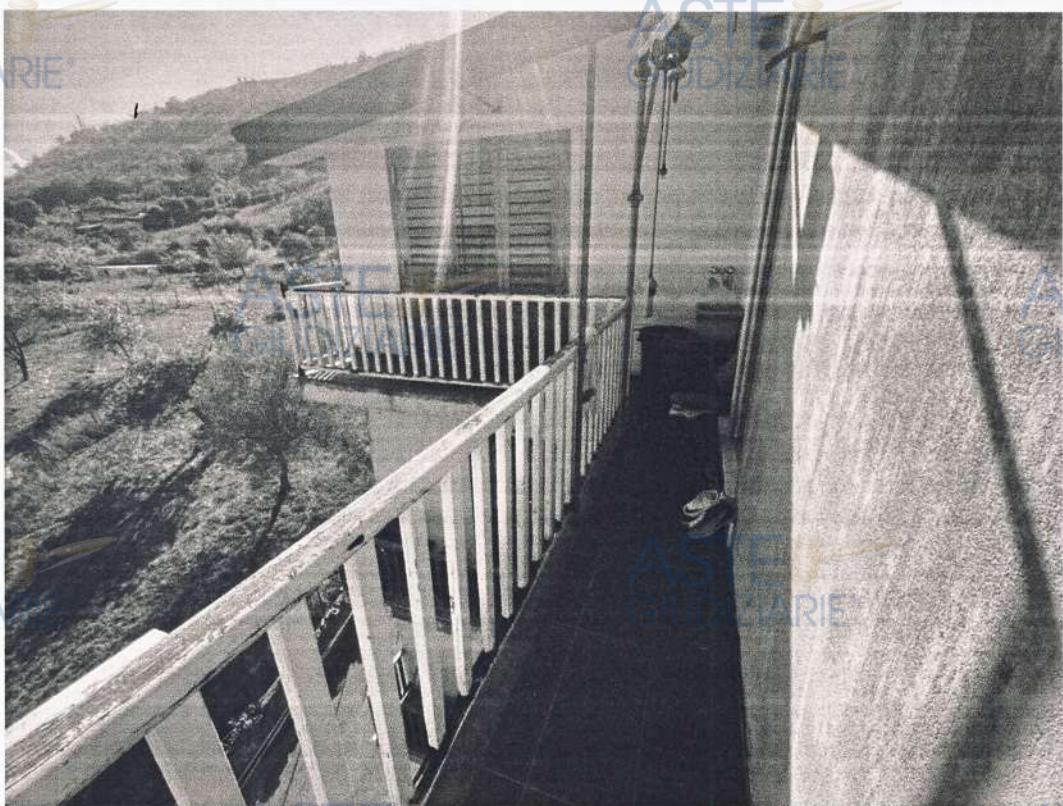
disimpegno accesso camere da letto - fg. 5 - p.lla 293 sub 5
